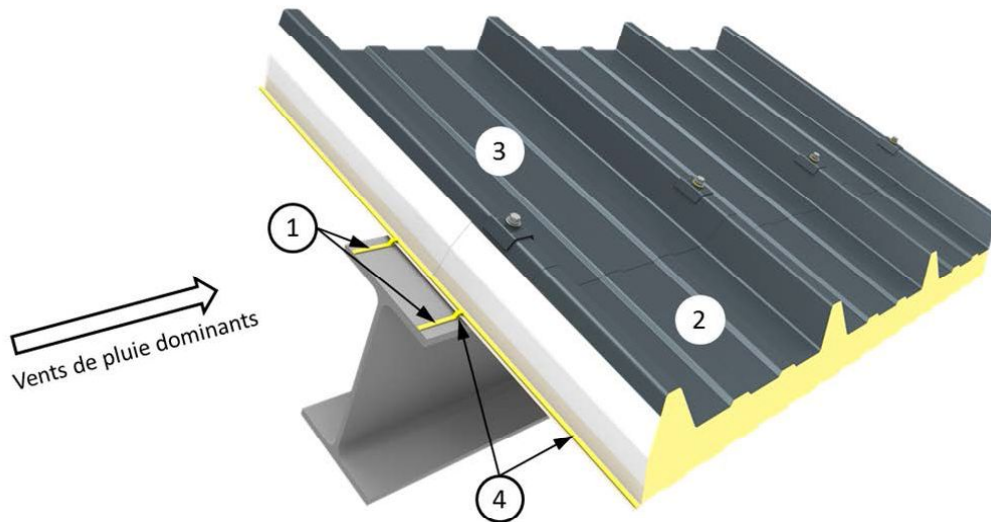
Détail sur appui – Joints sur appuis au droit d'un recouvrement transversal de panneaux sans complément d'étanchéité (CE) – locaux climatisés (cf. §7.5)
